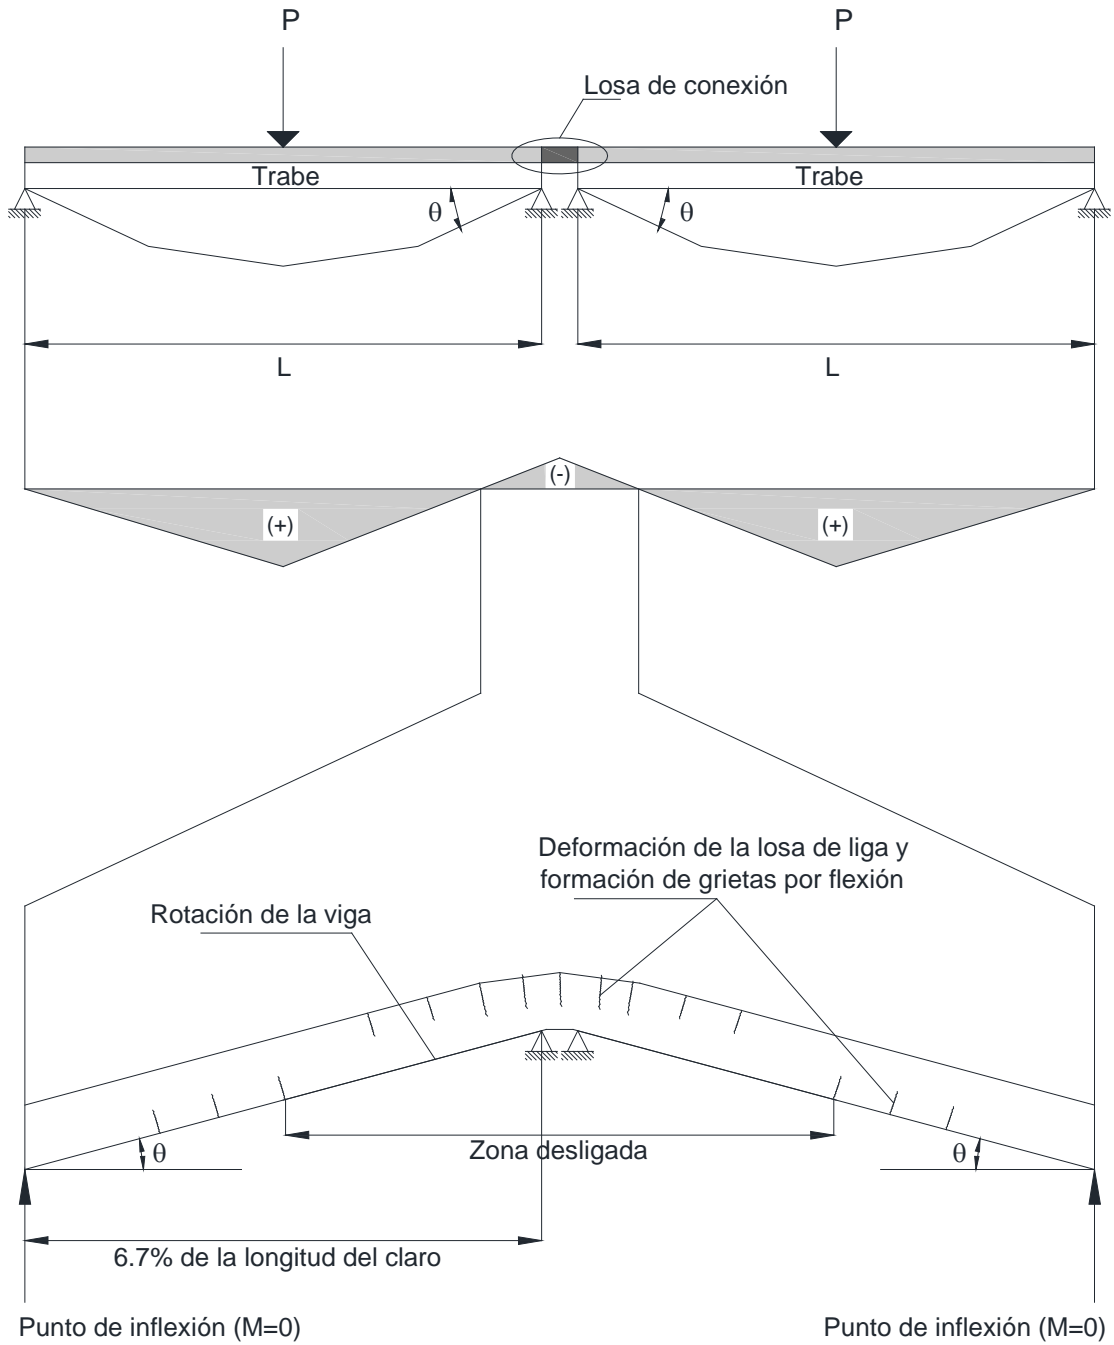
Losa de conexión y esquema de la flexión de la cubierta en la zona desligada.
